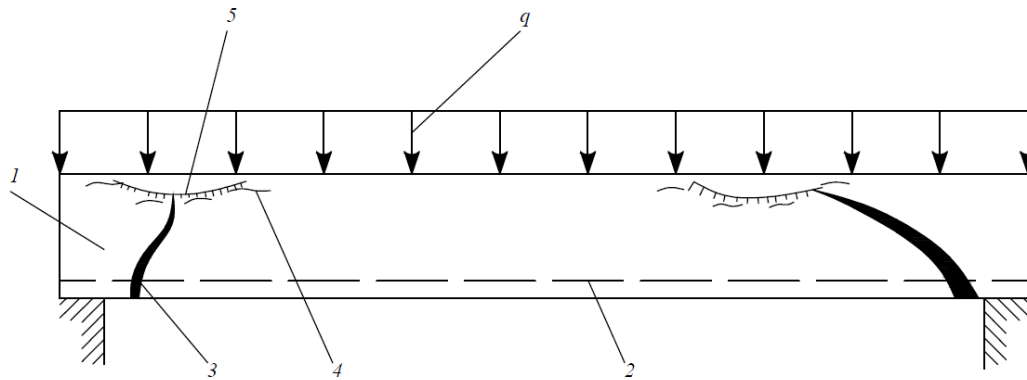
Трещины и разрушение бетона в наклонном сечении:
